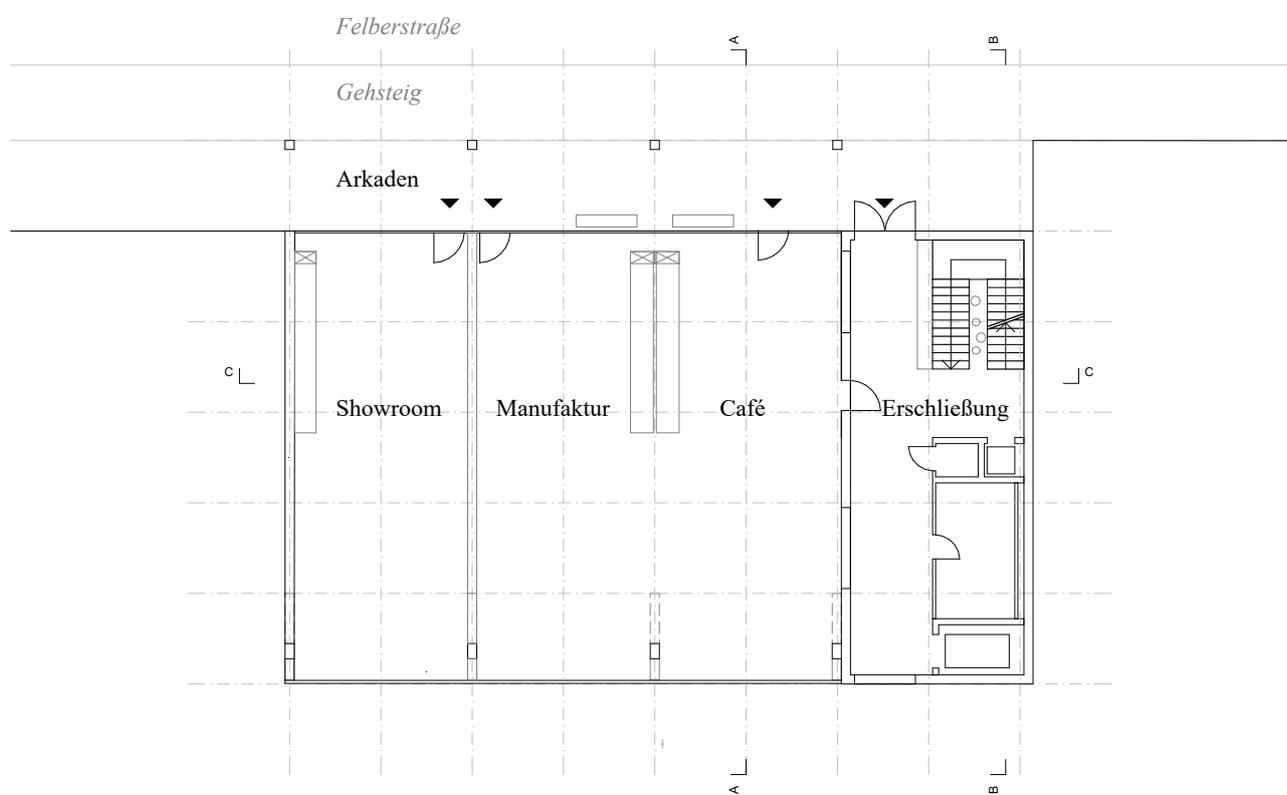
Grundriss Erdgeschoss, M 1:250
